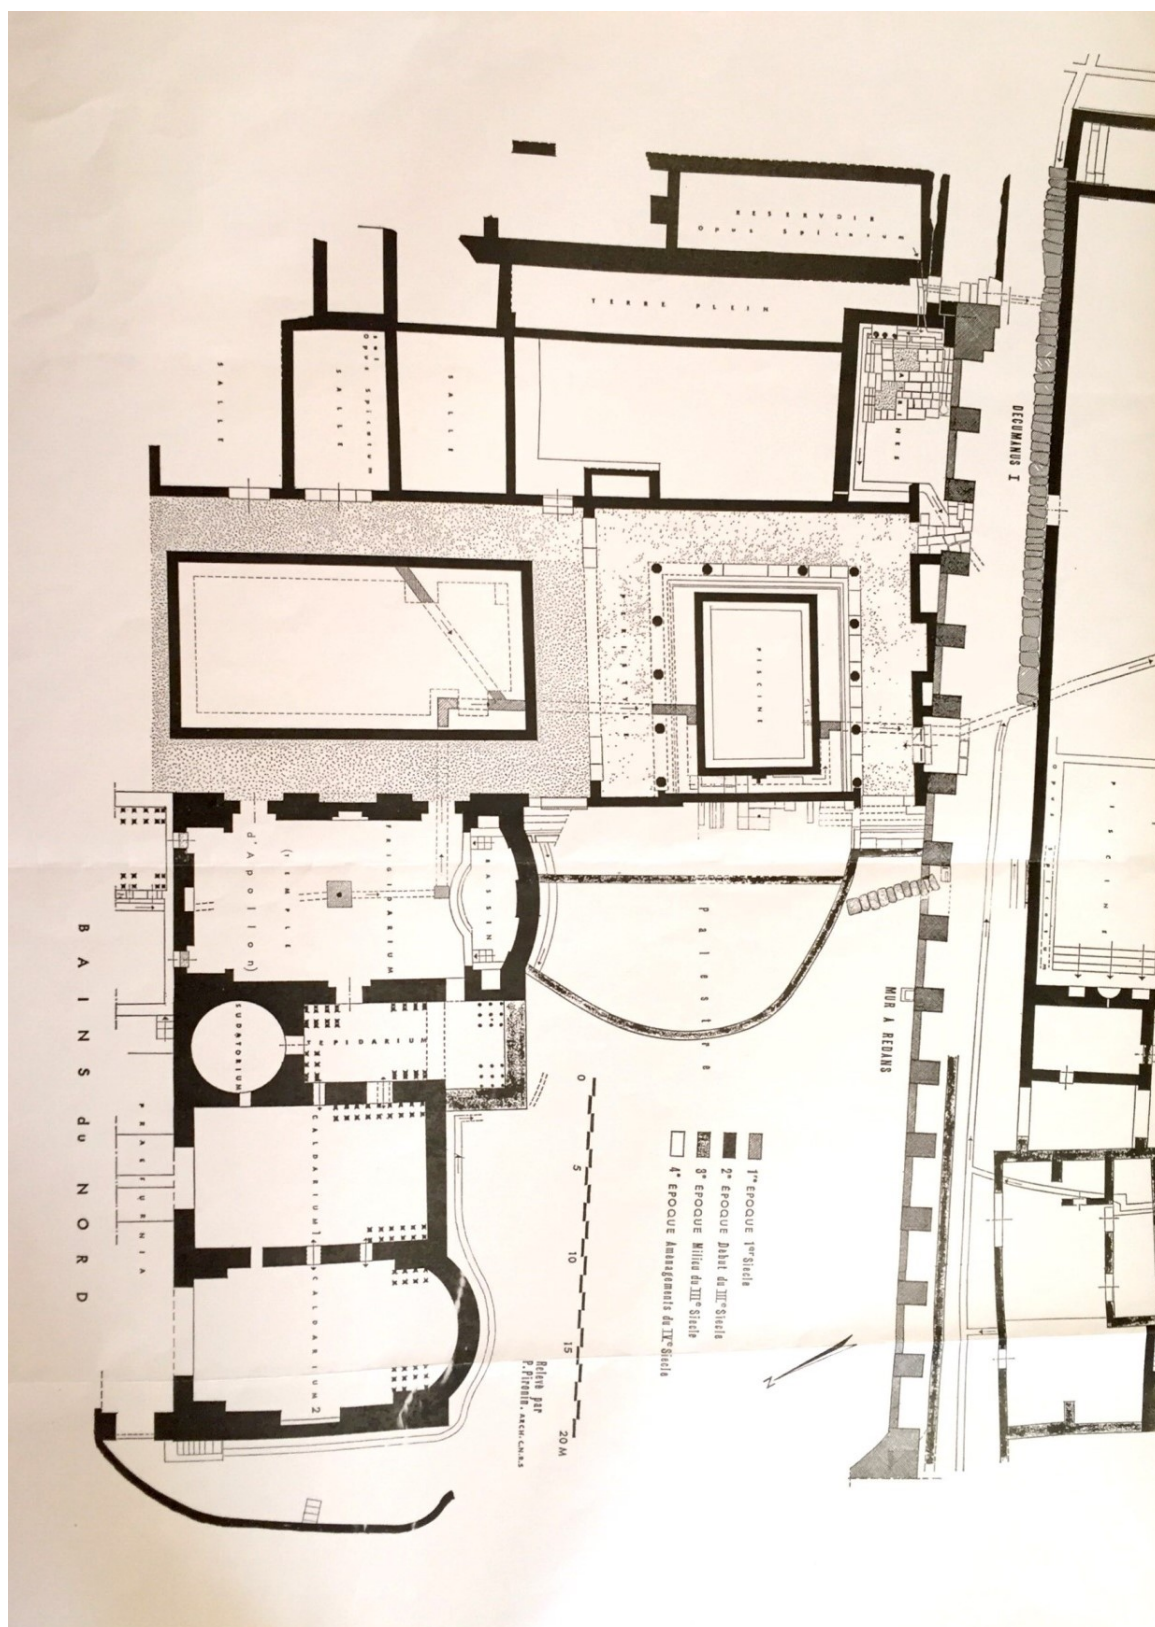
, Pianta delle Terme Settentrionali di *Cemenelum* (BENOIT 1977, planche XXX)
